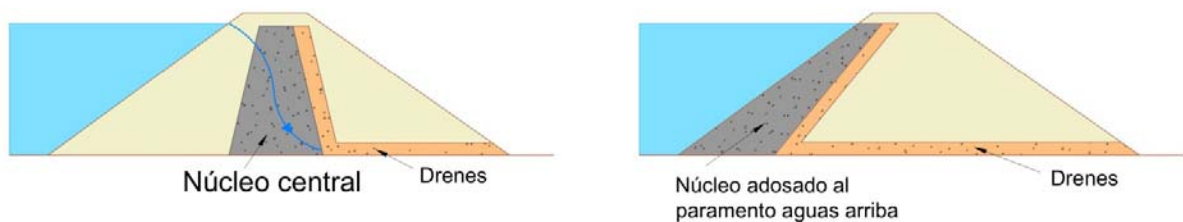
Presa zonadas con núcleo impermeable de arcilla.
